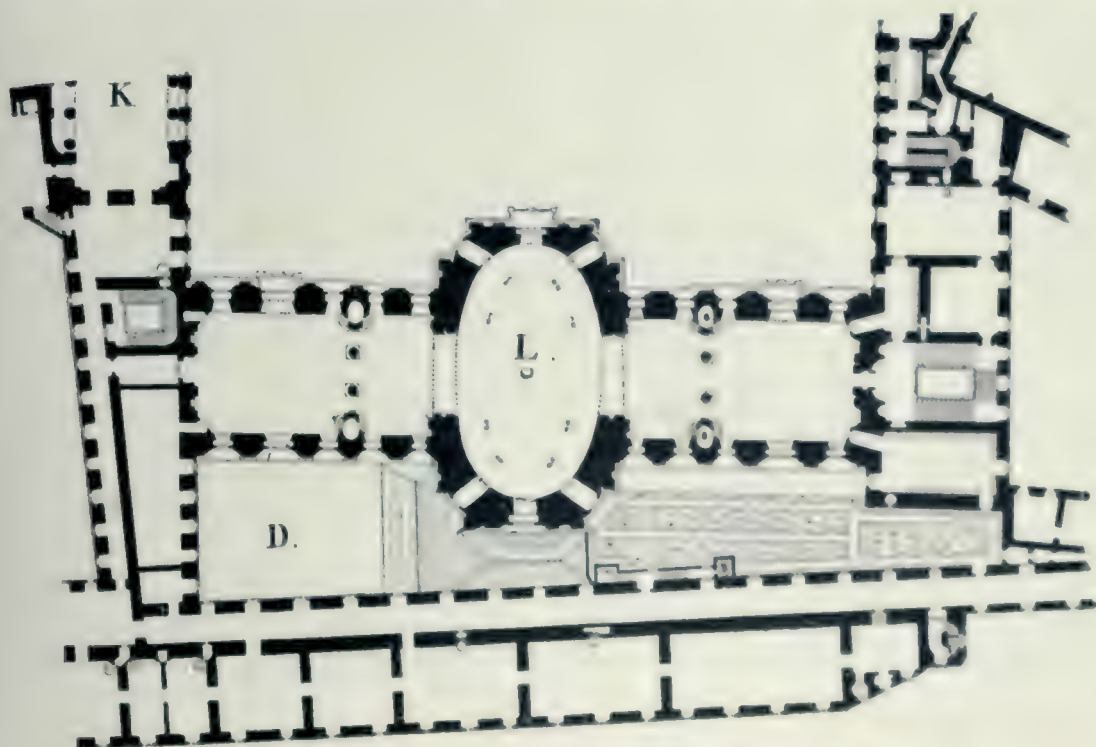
Ausschnitt aus dem „Grundriß der Kaiserburg in Wien“
